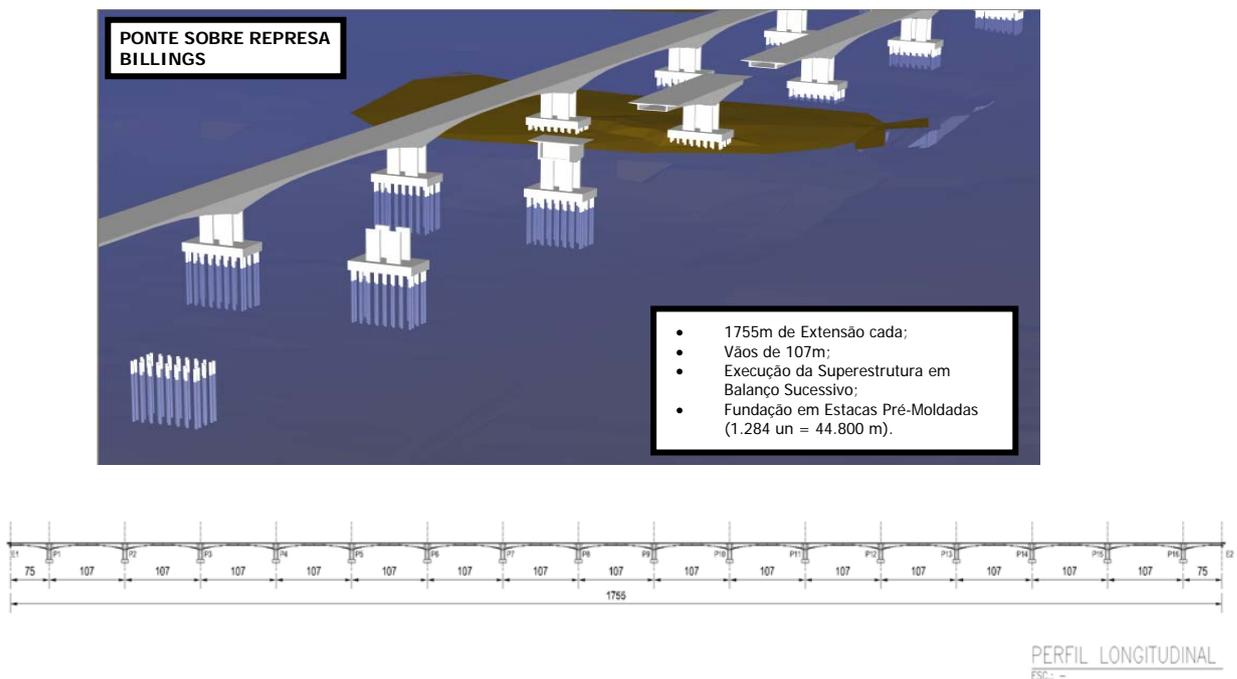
Vista e perfil longitudinal da ponte sobre a Represa Billings (cortesia Consórcio Queiroz Galvão CR Almeida)
